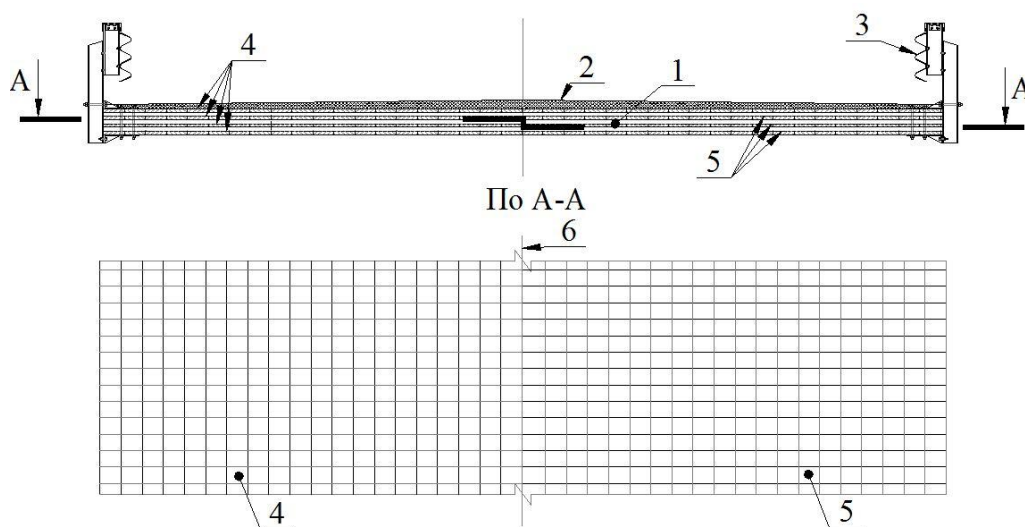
Поперечное сечение и план клееной деревоплиты плитного пролетного строения из перекрестных досок.
